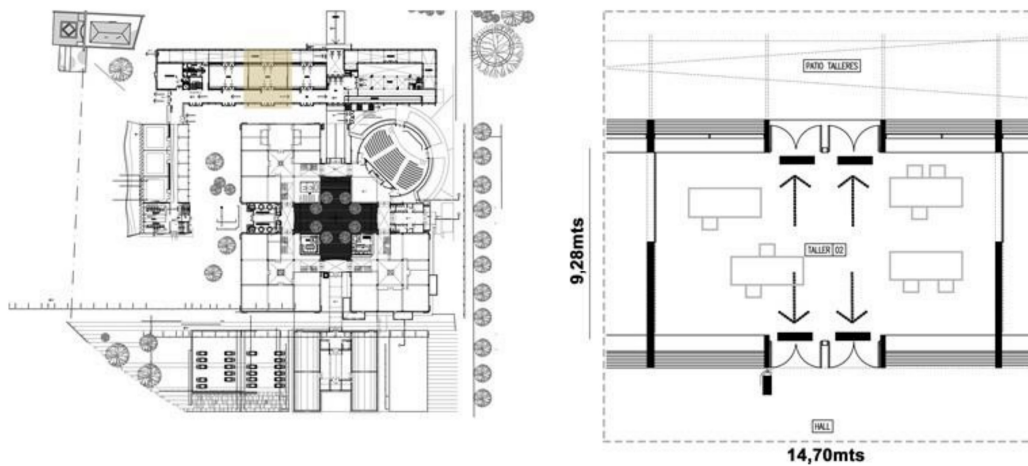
Planimetría General del Edificio FAUD con ubicación del local y Planta General del Aula.
